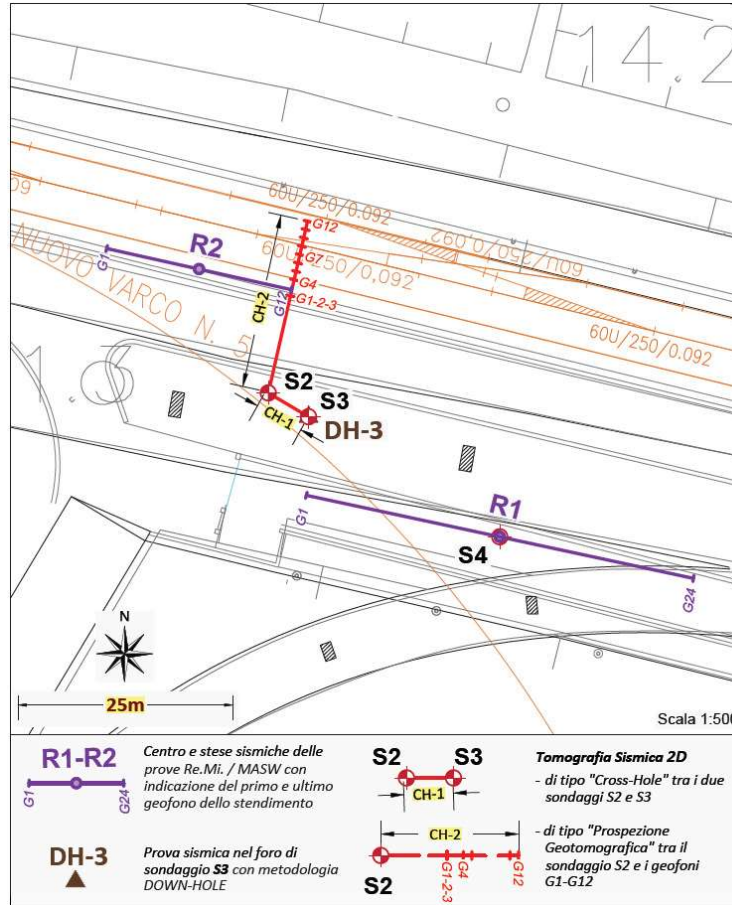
Planimetria delle opere in progetto con la localizzazione dei sondaggi eseguiti.
